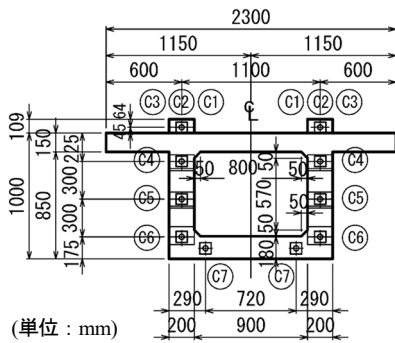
供試体 G1 (R 側) の側面図 (ケーブル配置図) ※R 側からの透視図
